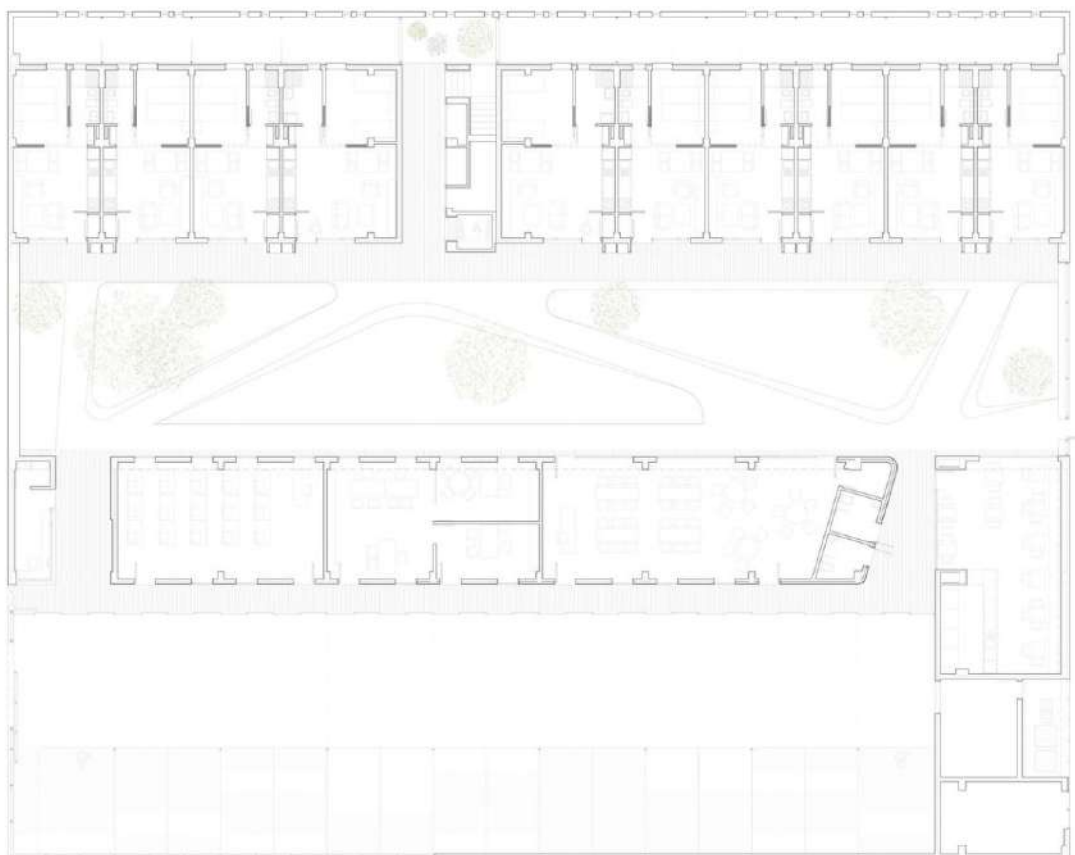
Planta baja Residencia Universitaria. Fuente: www.archdaily.com
